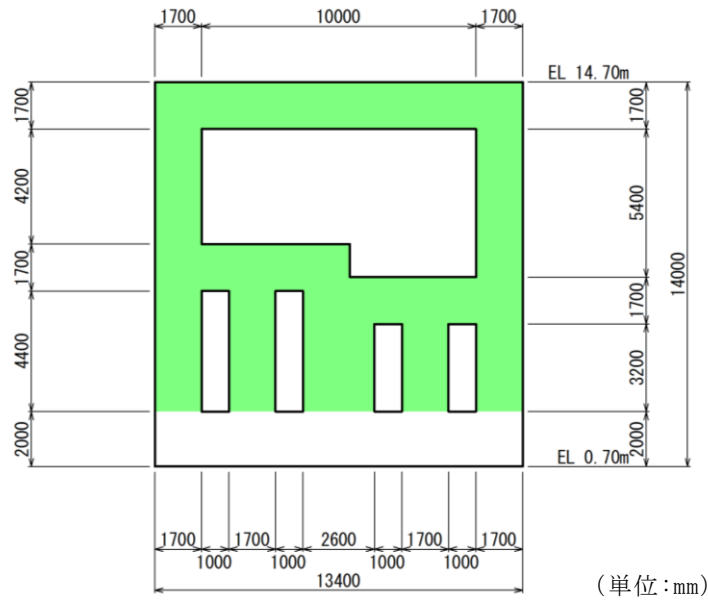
第 1 ベントフィルタ格納槽 評価対象断面図 (C-C 断面位置)
